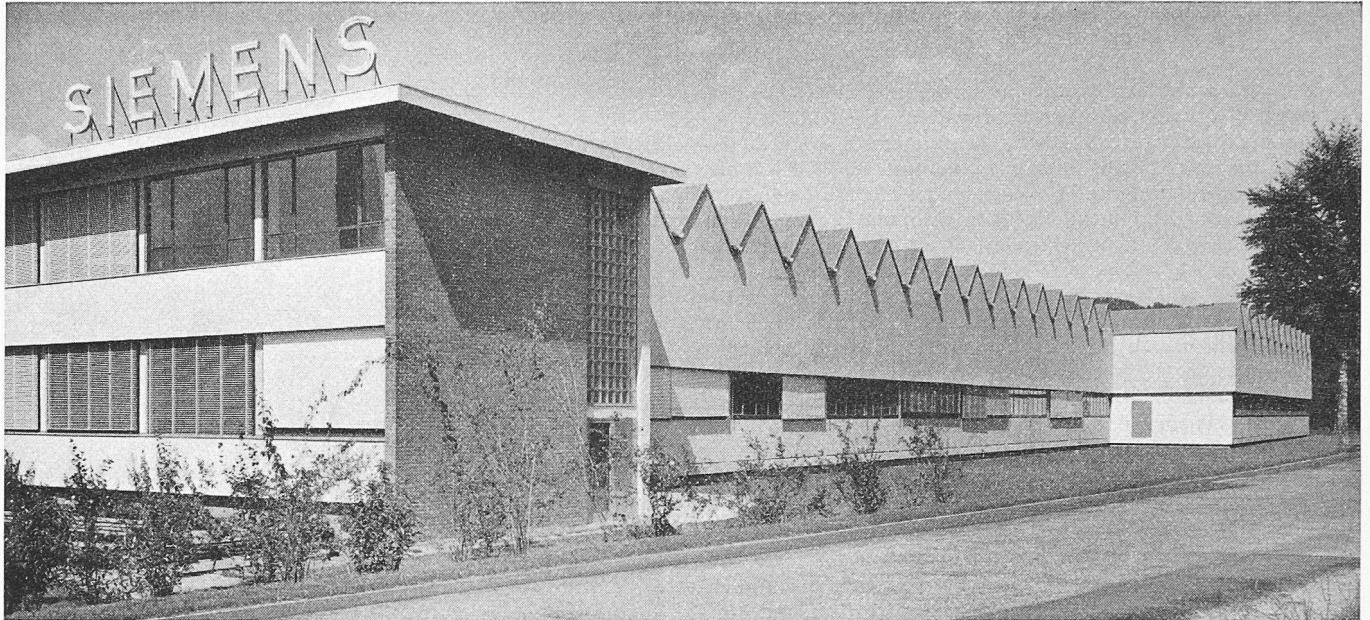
Aussenansicht der Siemens-Bauten in Weiningen ZH mit der Shedfaltwerkhalle
